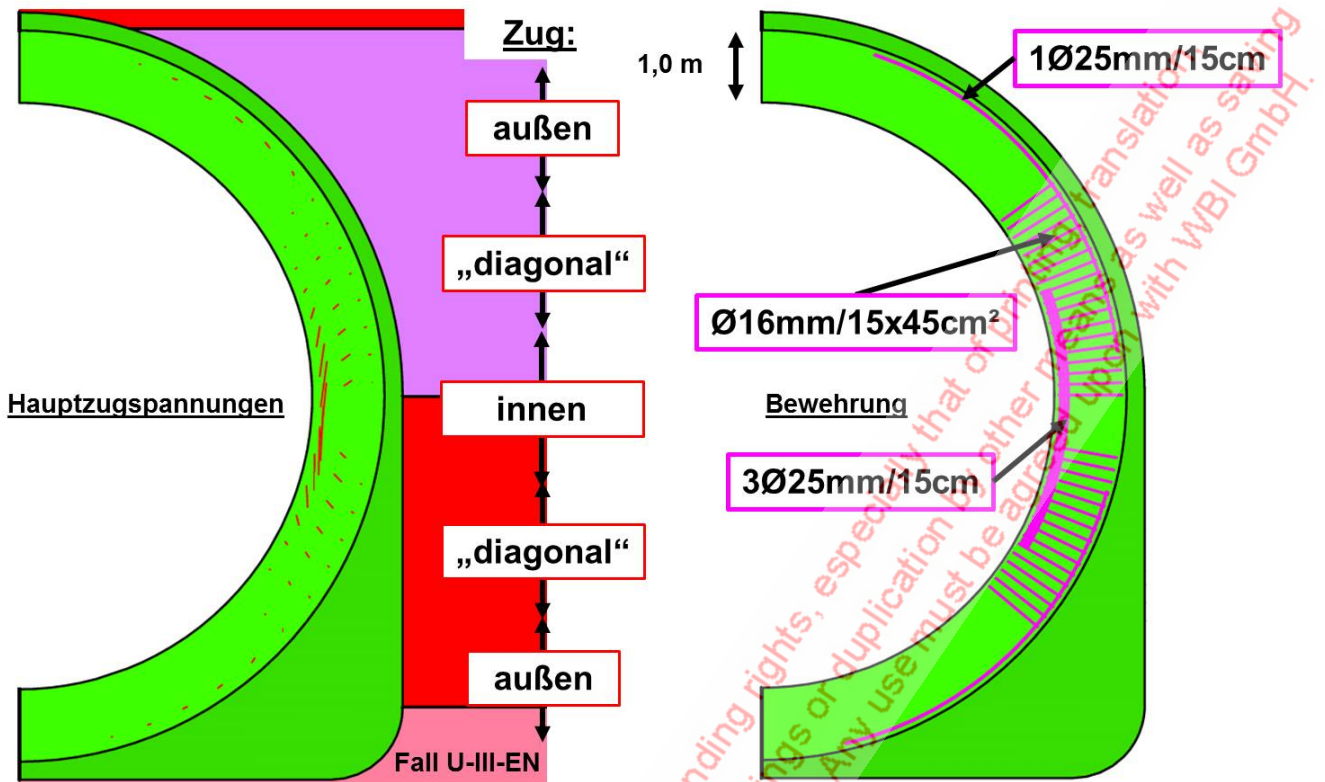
Hauptzugspannungen und Bewehrungsführung (Beispiel Fall U-III-EN)
